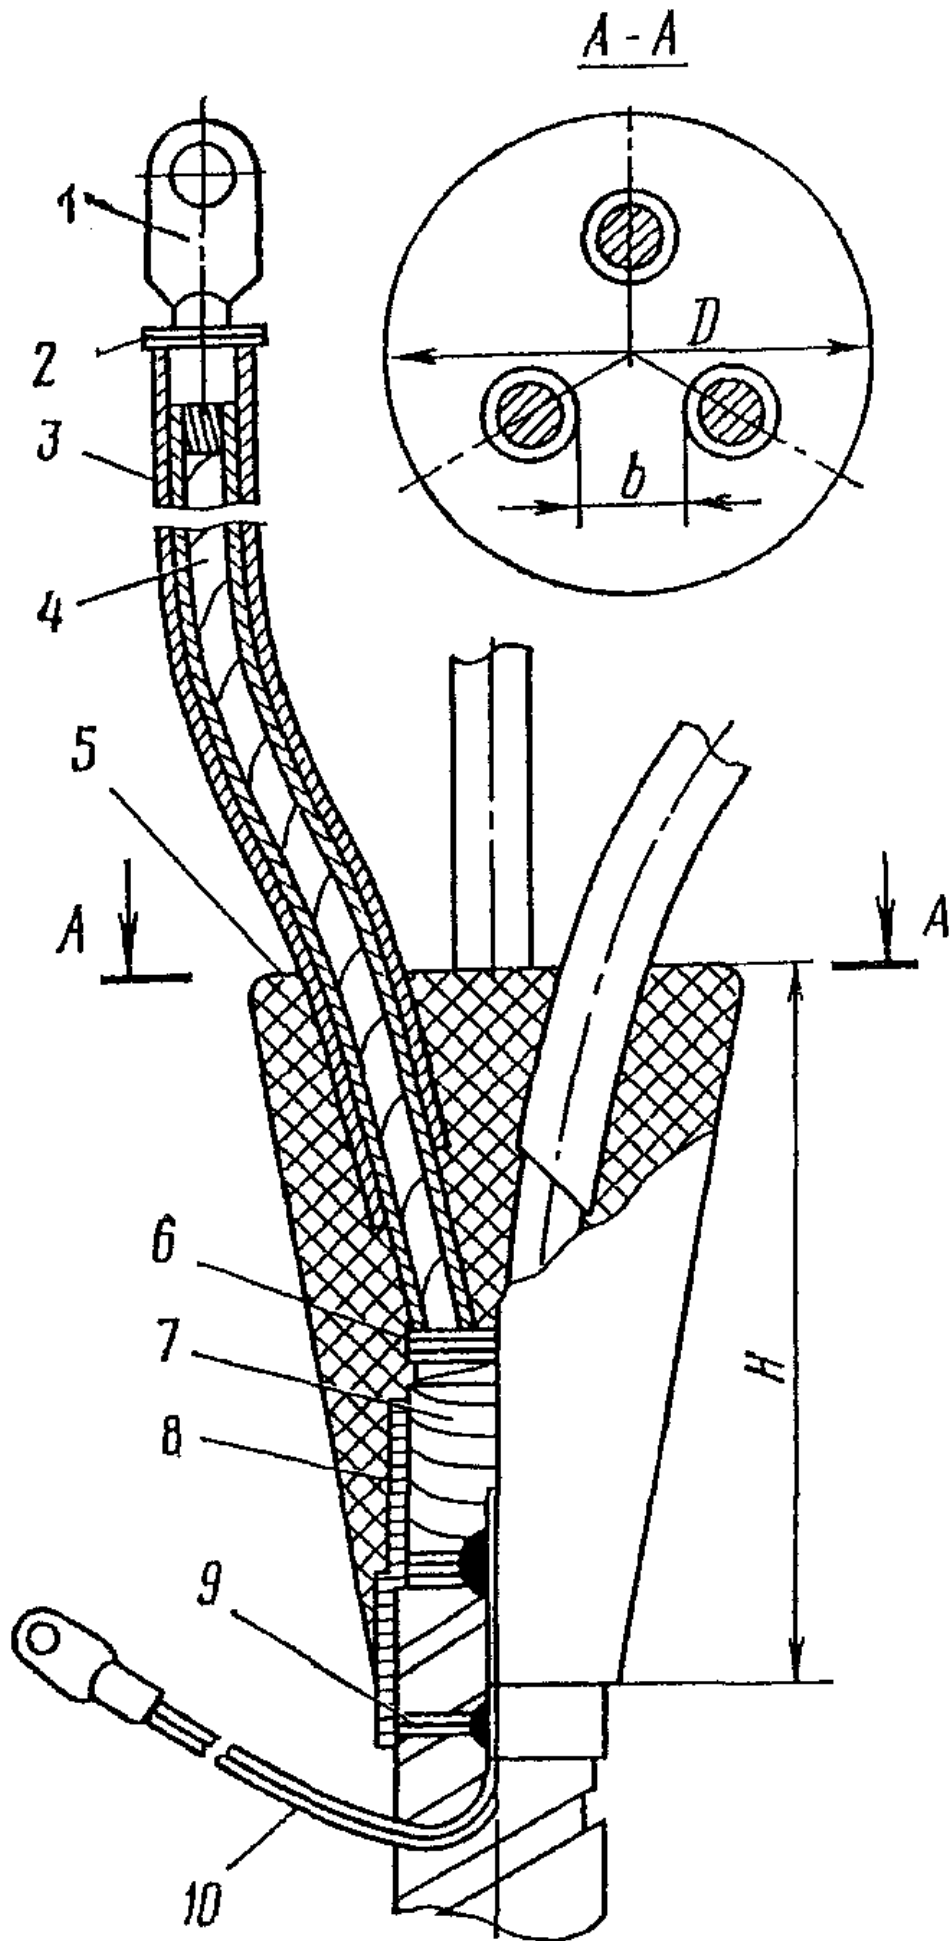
Эпоксидная концевая заделка исполнения КВЭн с трубками из найритовой резины: 1 - наконечник; 2 - бандаж или хомут; 3 - трубка из найритовой резины; 4 - токоведущая жила; 5 - корпус из эпоксидного компаунда; 6 - бандаж из суровых ниток на поясной изоляции; 7 - оболочка; 8 - двухслойная подмотка; 9 - проволочный бандаж для закрепления провода заземления; 10 - провод заземления; 11 - оболочка; 12 - провод заземления
